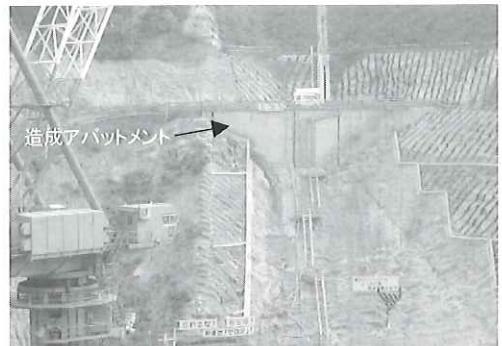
石井ダム(兵庫県)における標準型造成アバットメントの施工
